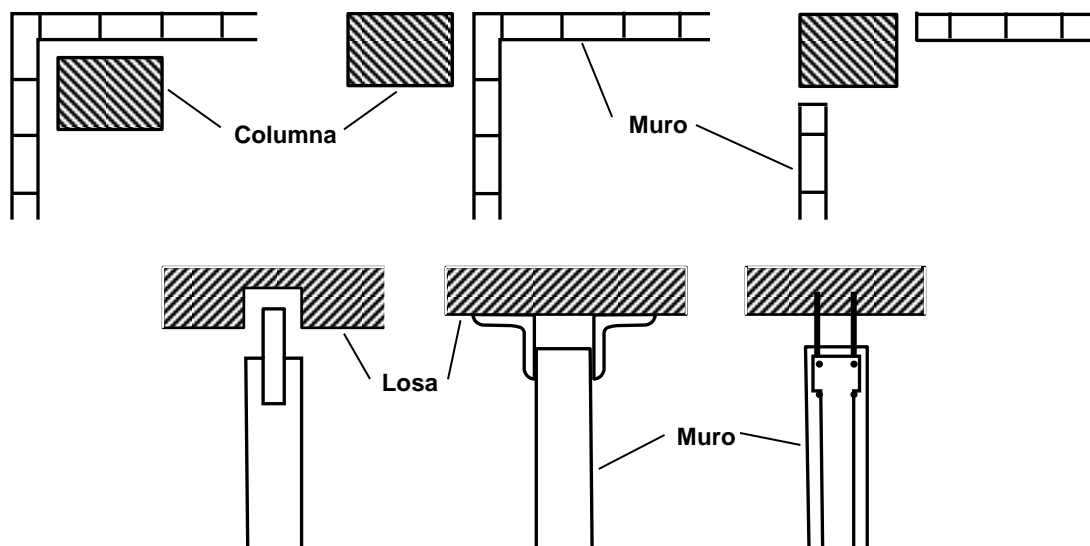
Alternativas para desligar los muros de la estructura. Arriba, vista en planta. Abajo, vista de alzado
